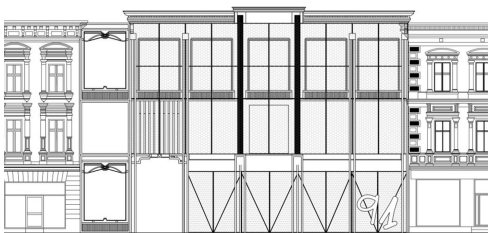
Brama z projektu przebudowy z 1911r. jako inspiracja do konstrukcji przejścia
